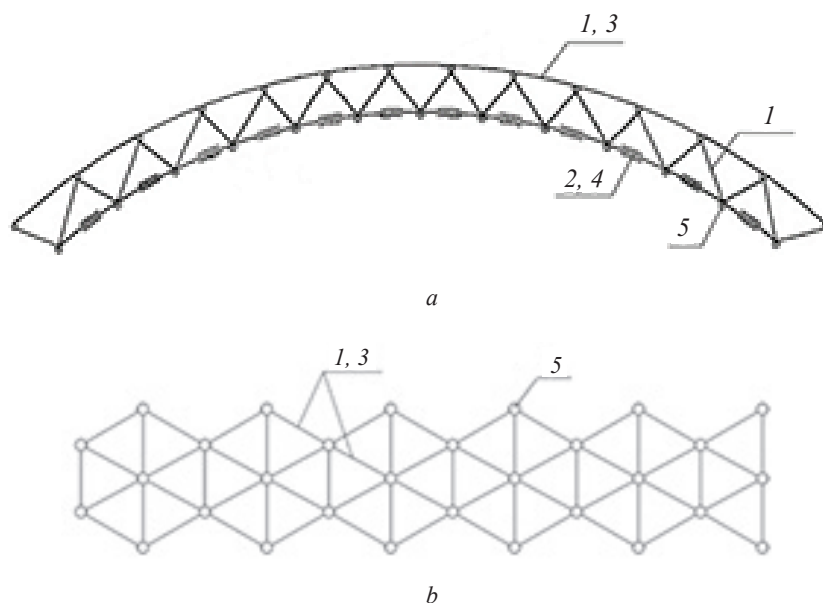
Схема трансформируемой пространственной стержневой арки: *a* — профиль арки; *b* — вид сверху; 1 — верхний пояс; 2 — нижний пояс; 3 — стержни стандартной длины; 4 — стержни укороченные; 5 — узел шарнирного соединения стержней (рисунок авторов)
